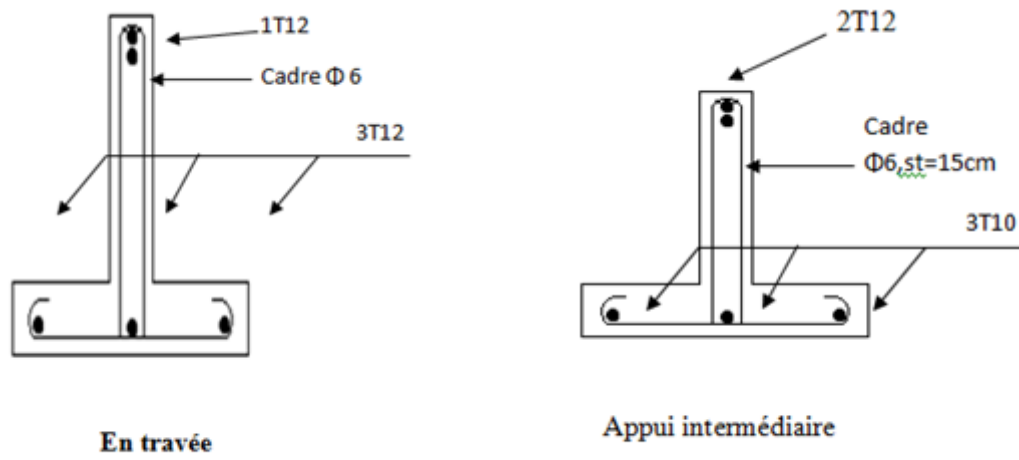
Dessin de ferrailage des poutrelles du plancher terrasse
